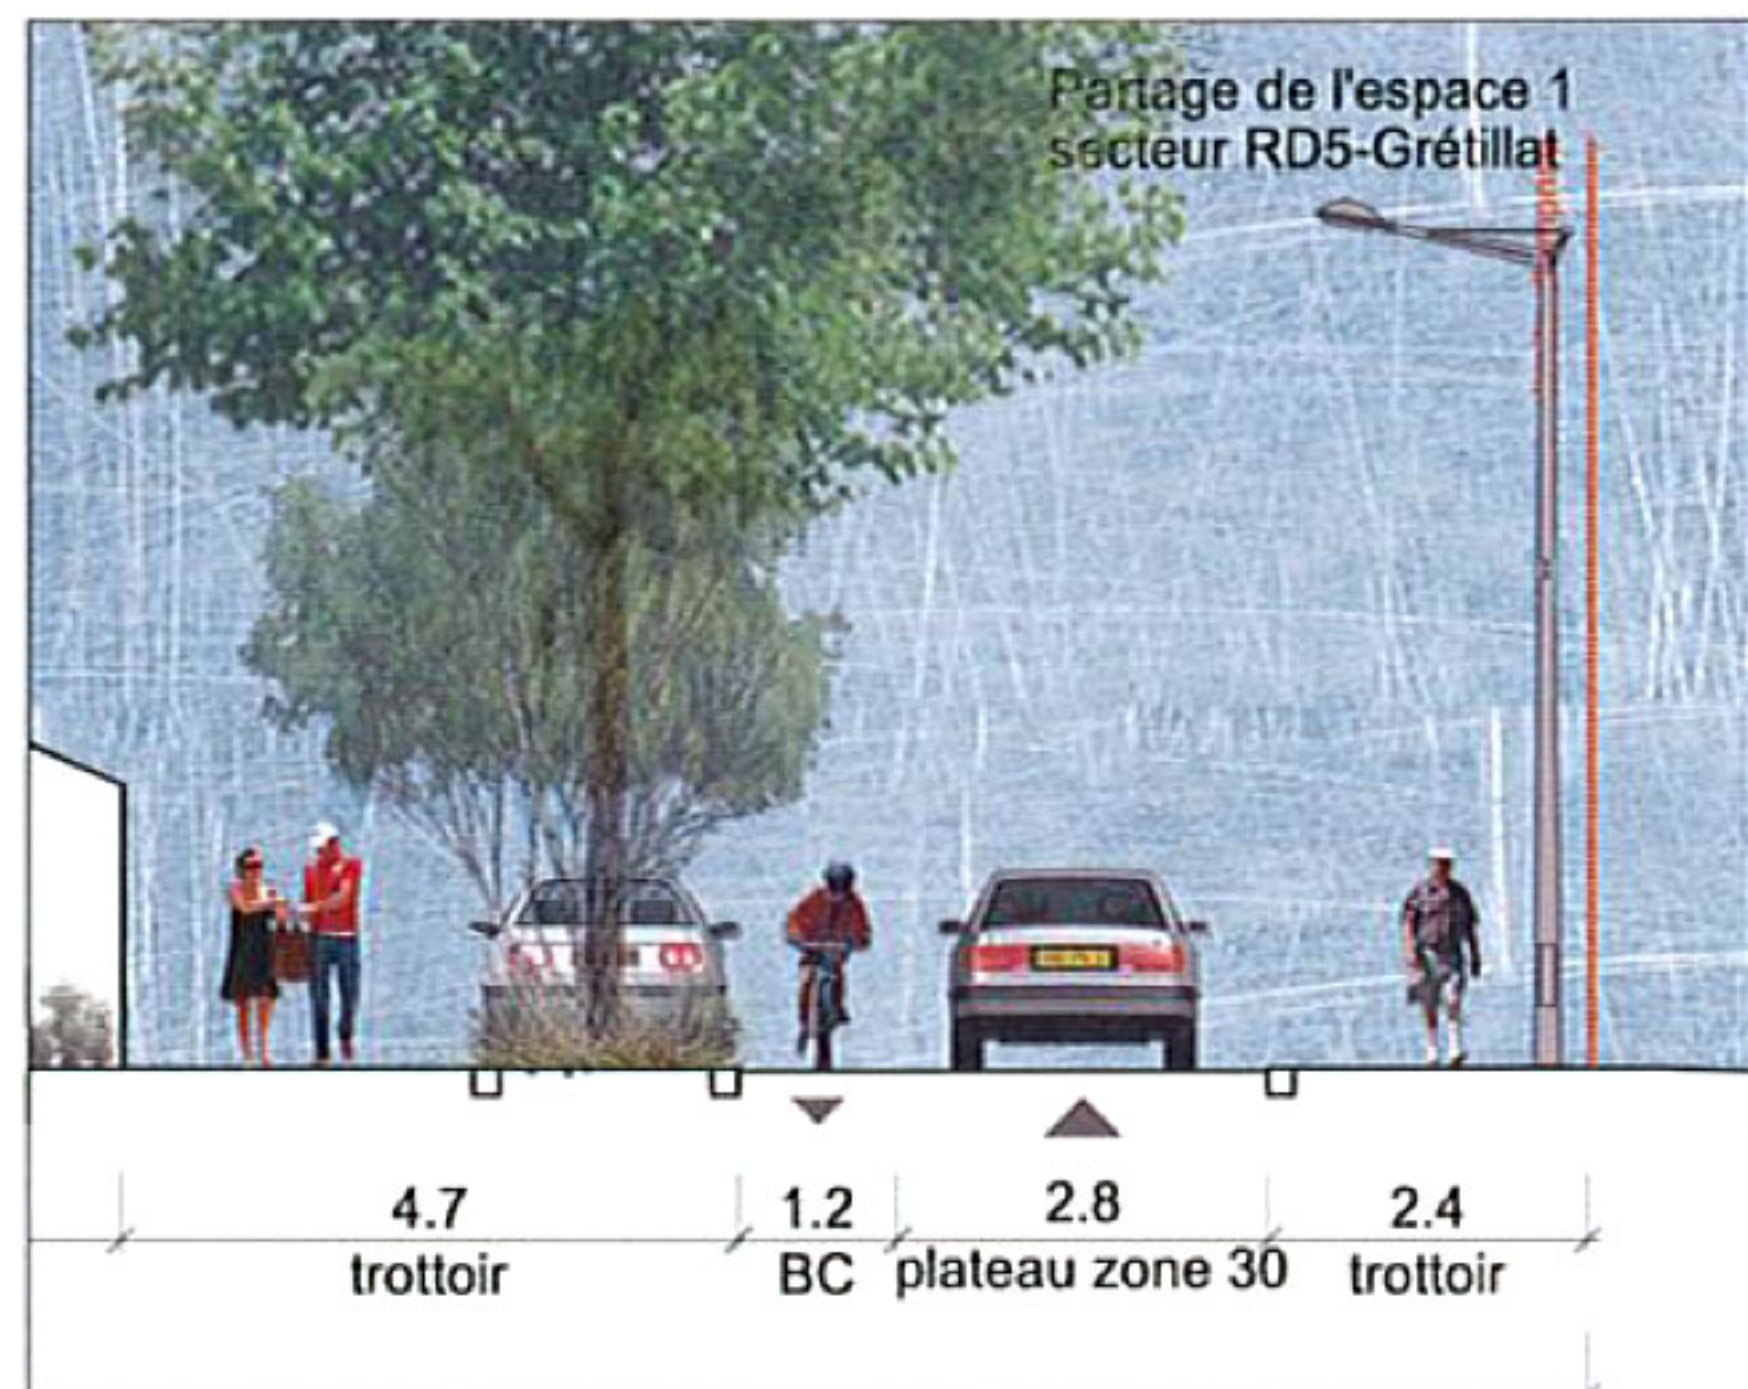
Requalification d'une rue en zone 30, Vitry sur Seine (94)
